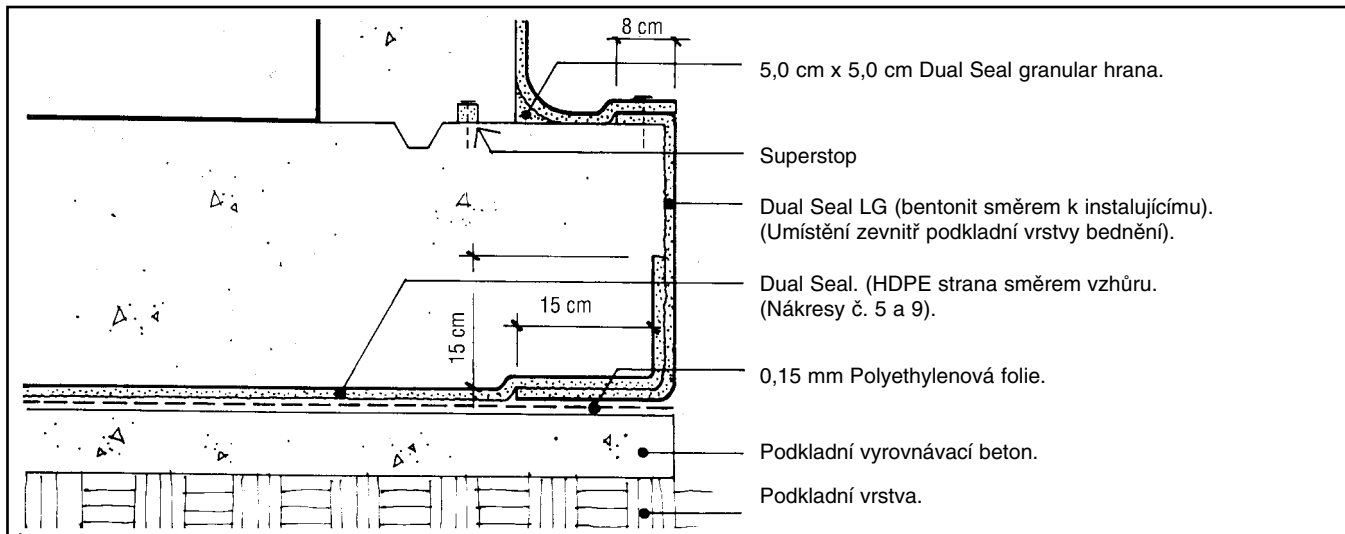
Spojení svislé konstrukce/základu a základové desky/ochranné desky.
